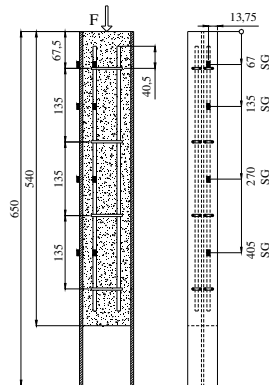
Posição das armaduras de reforço do betão e dos extensómetros.
